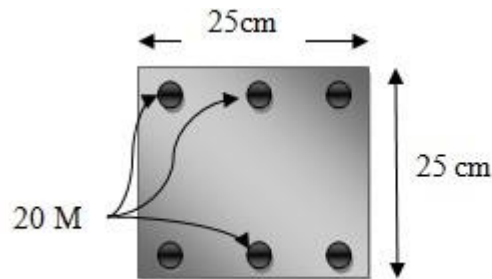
Ferrailage du poteau en traction selon le code CSA
